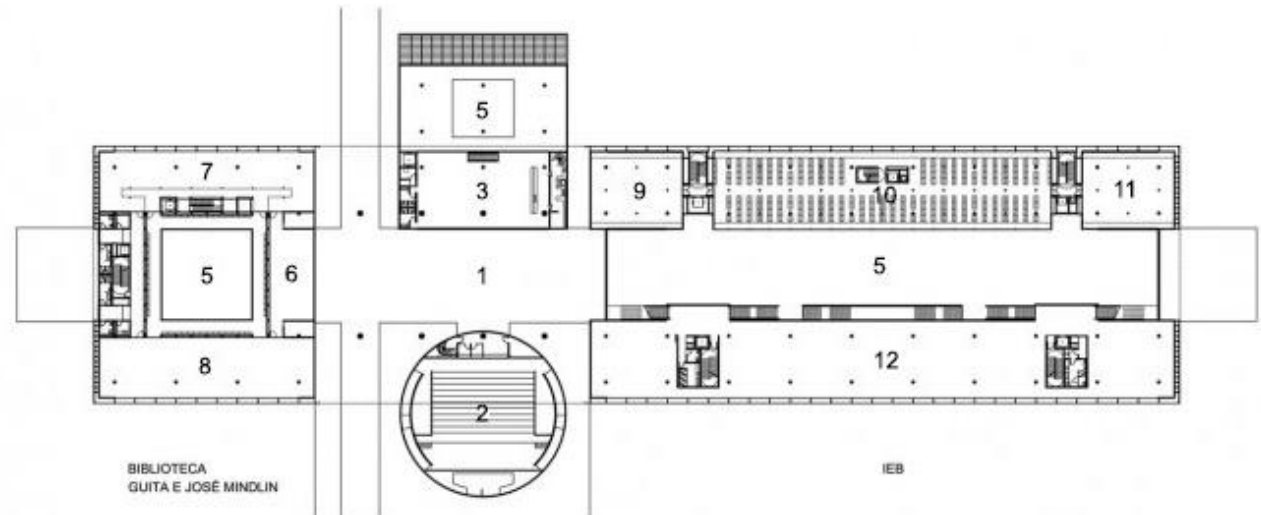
Planta baixa 1 pavimento. Fonte: Archdaily (2019c).
